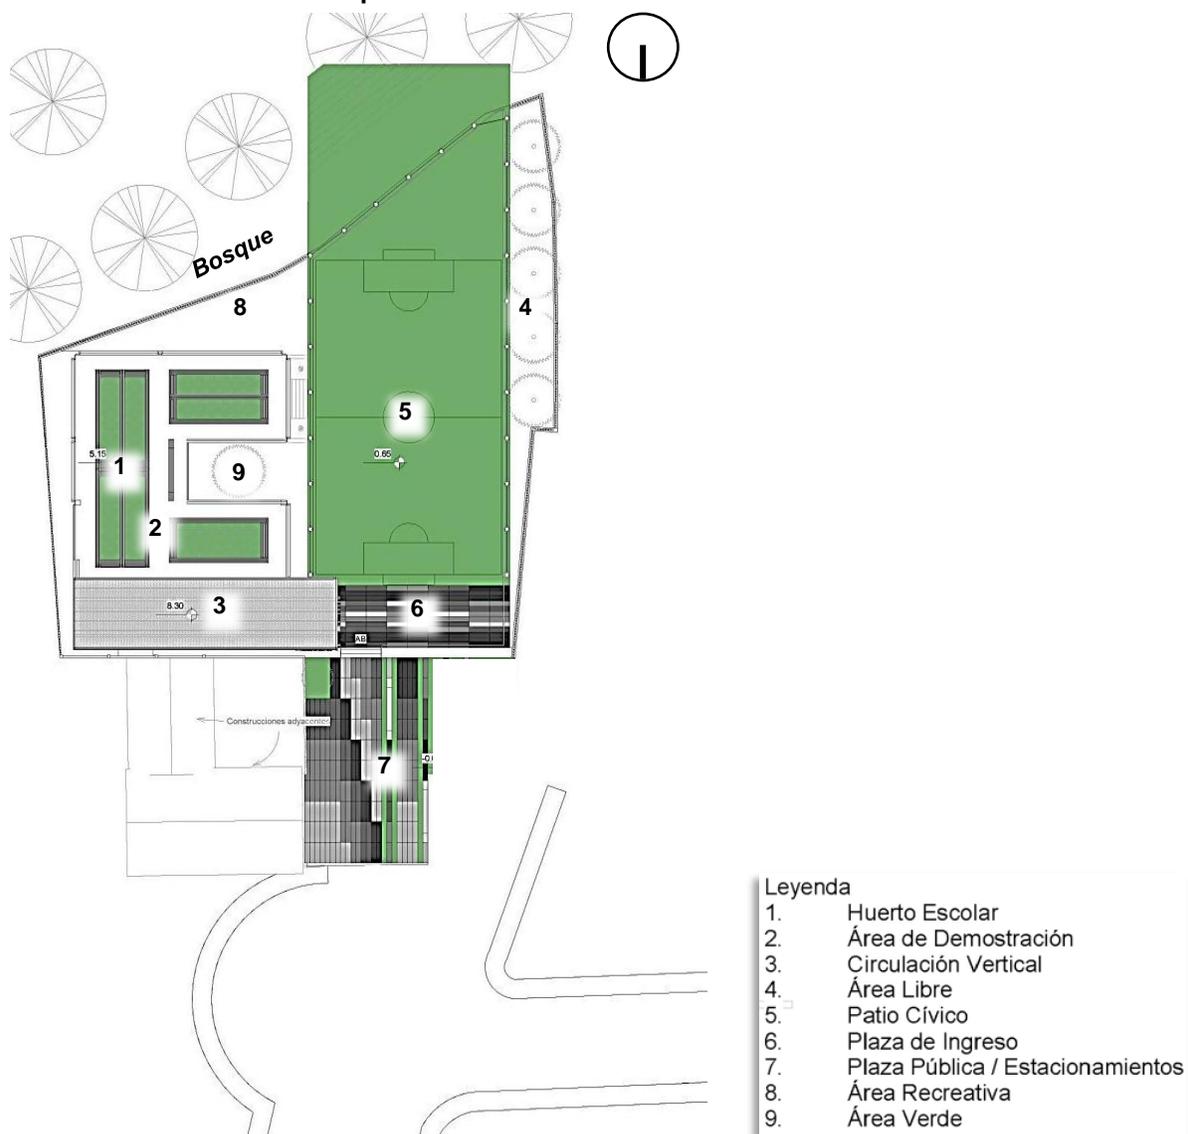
Plano Arquitectónico Nivel + 2.15
